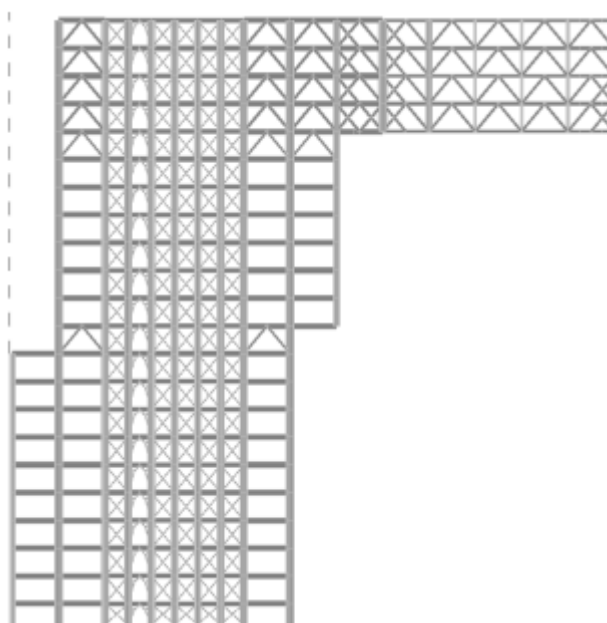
Переріз розрахункової схеми будівлі по ядру жорсткості і консолі ПК SCAD
